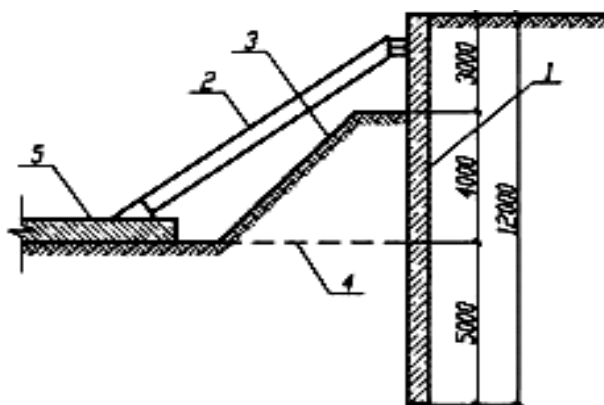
Крепление котлована с помощью подкосов: 1 — ограждающая конструкция; 2 — подкос; 3 — защитная берма; 4 — контур дна котлована; 5 — опорная плита [11]
